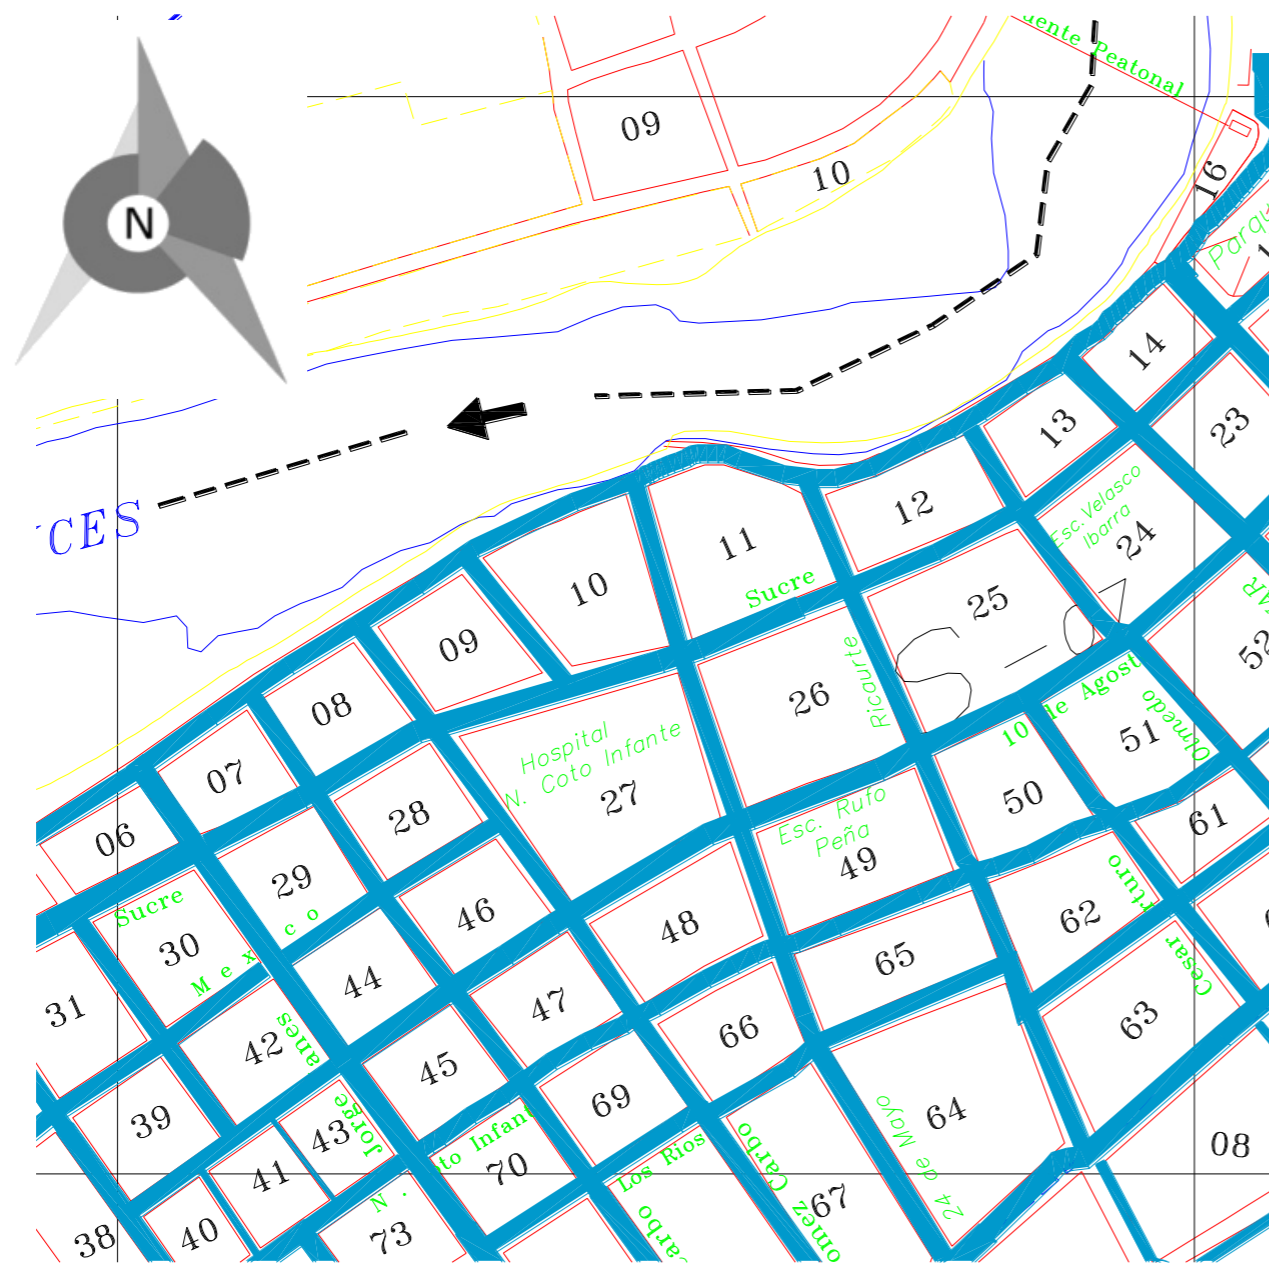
RED DE ALCANTARILLADO DEL CANTÓN VINCES
